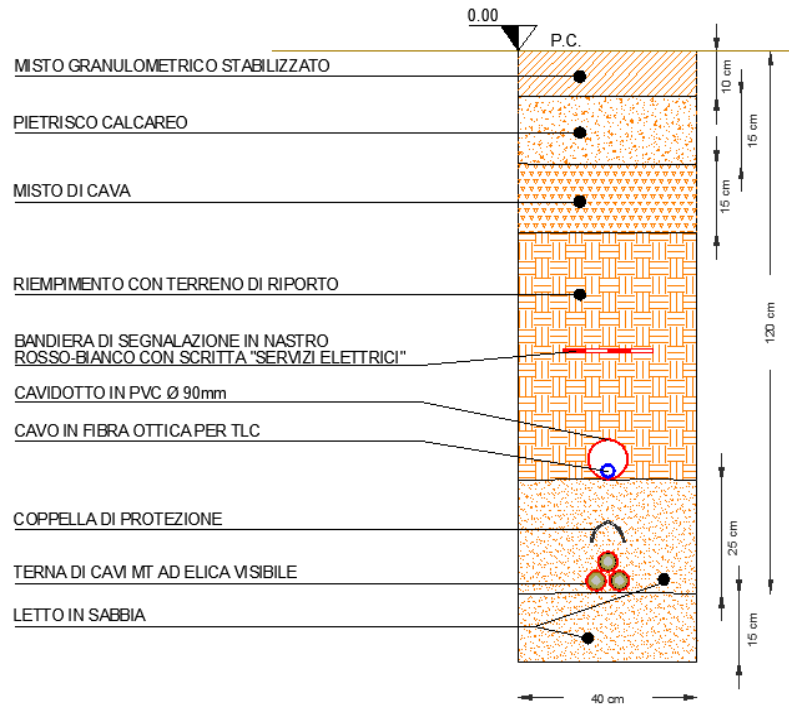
Sezione tipo di scavo per la posa del cavidotto su strada esistente.
